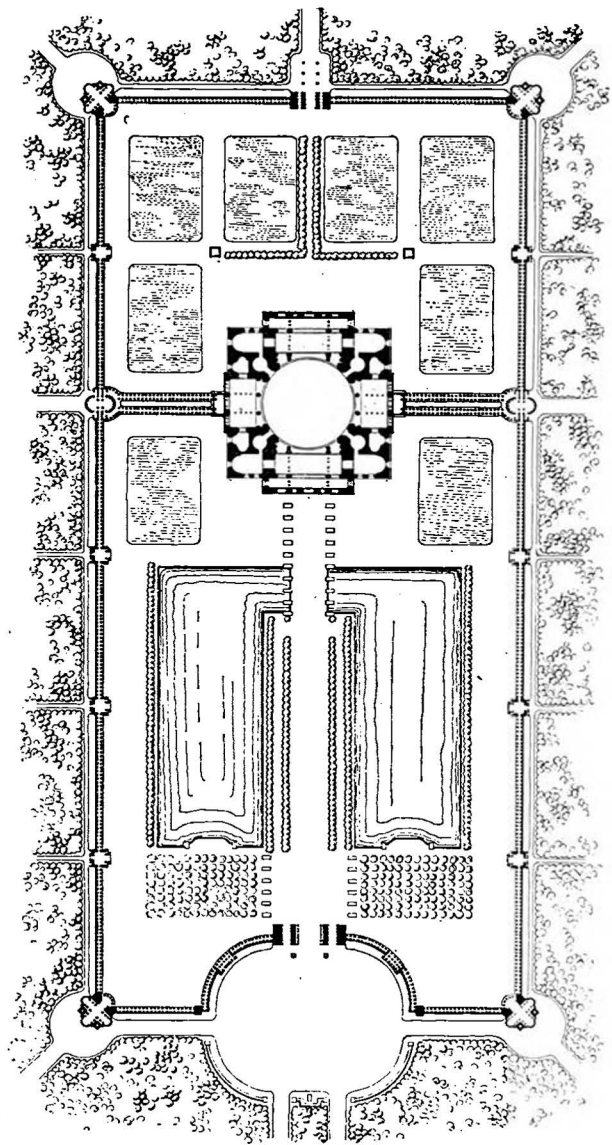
Kuppelbau mit Ehrenhof, Grundriß
